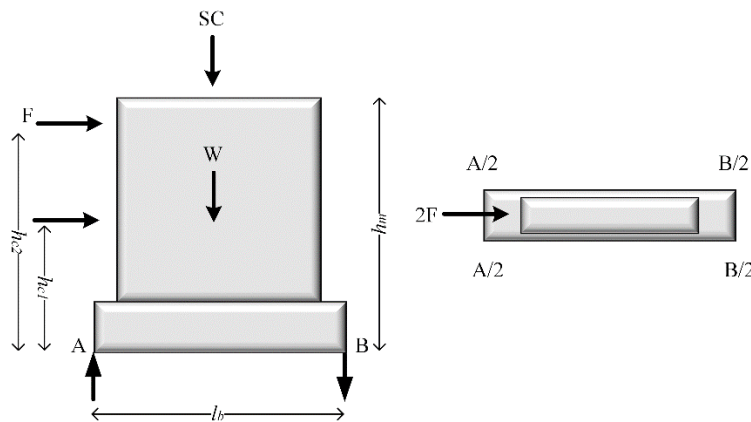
Vista frontal y en planta del muro ensayado y distribución de esfuerzo en la losa de reacción.
